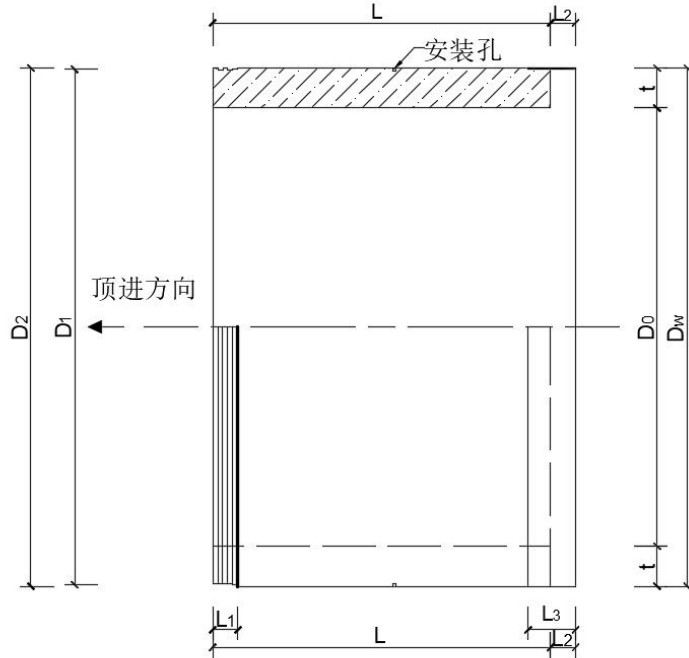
钢筋混凝土顶管圆形管节外型图
